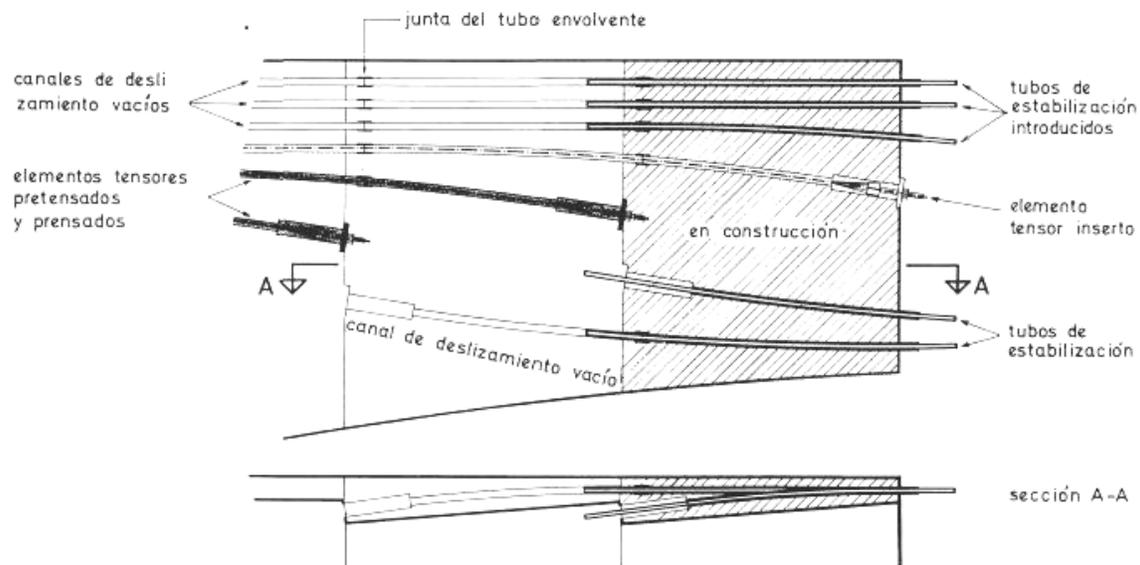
Ubicación de los cables tensores en una dovela intermedia.
